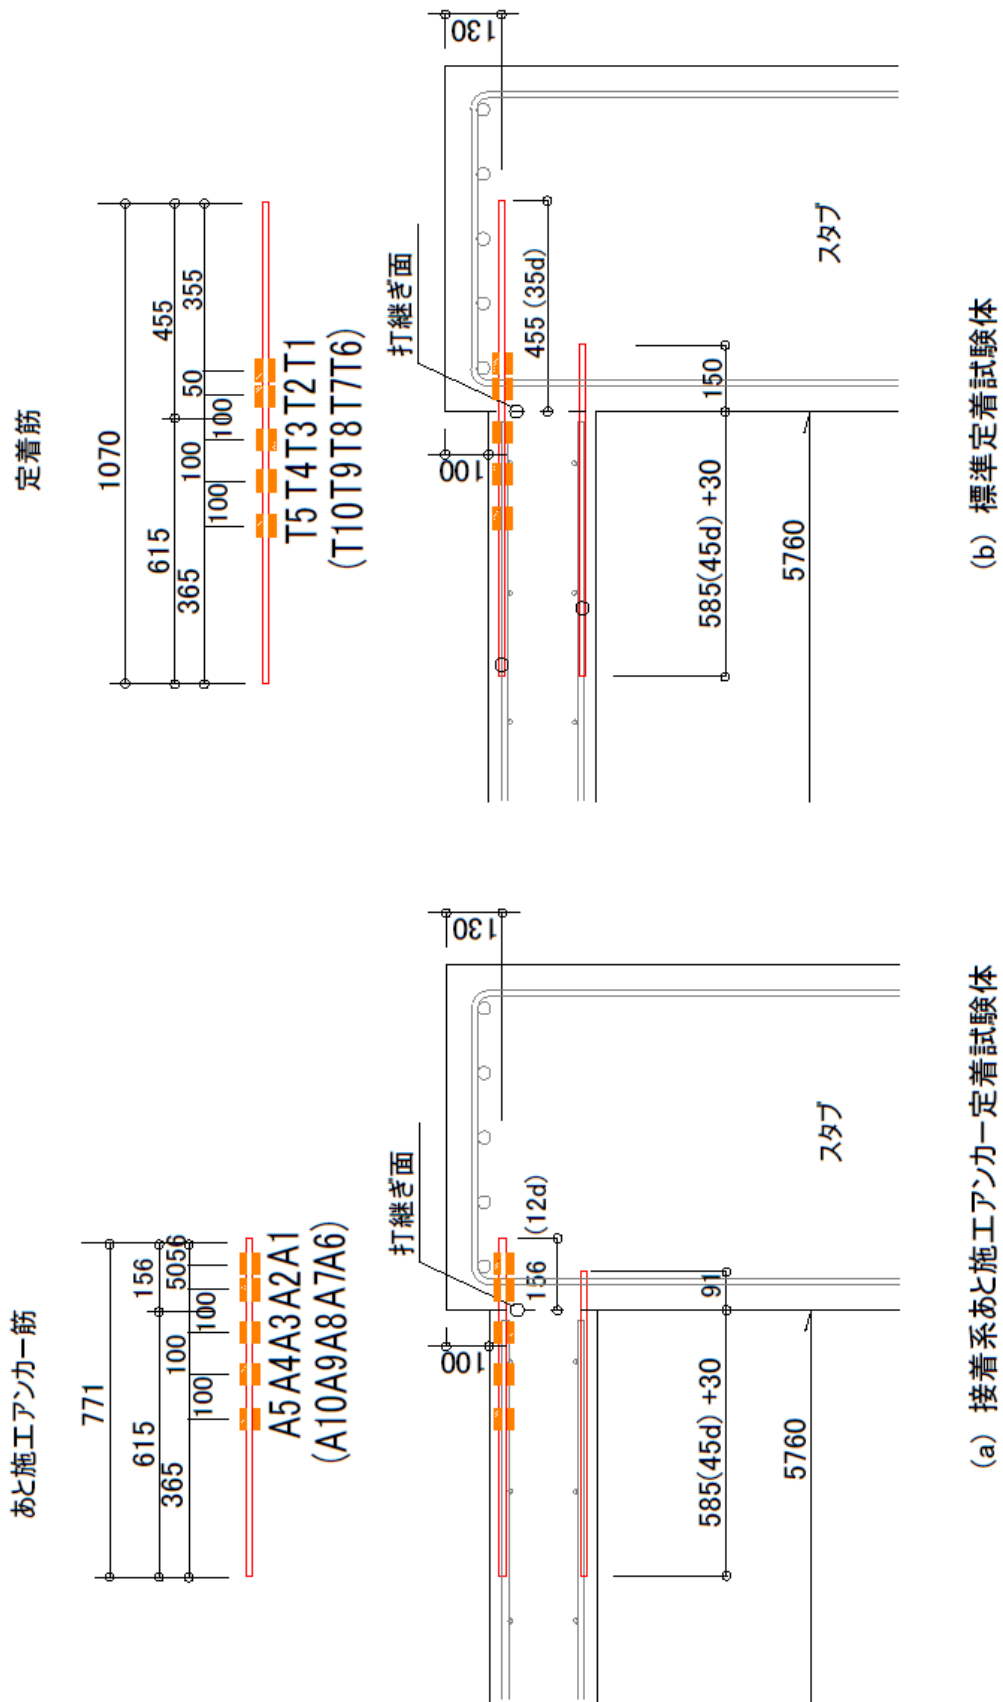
鉄筋(あと施工アンカー筋, 定着筋)ひずみ測定位置(AH, BA 試験体)
